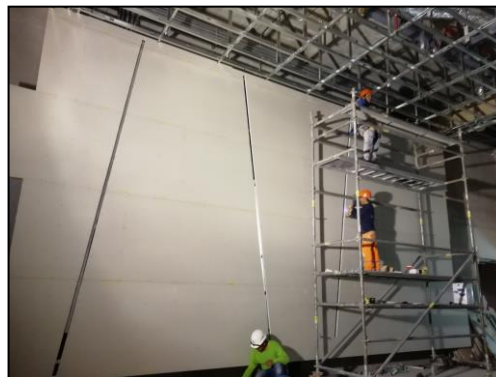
Instalación de perfilería de drywall en techo de concreto con refuerzos para instalación de planchas de aluminio, piso 1, vista 1.
